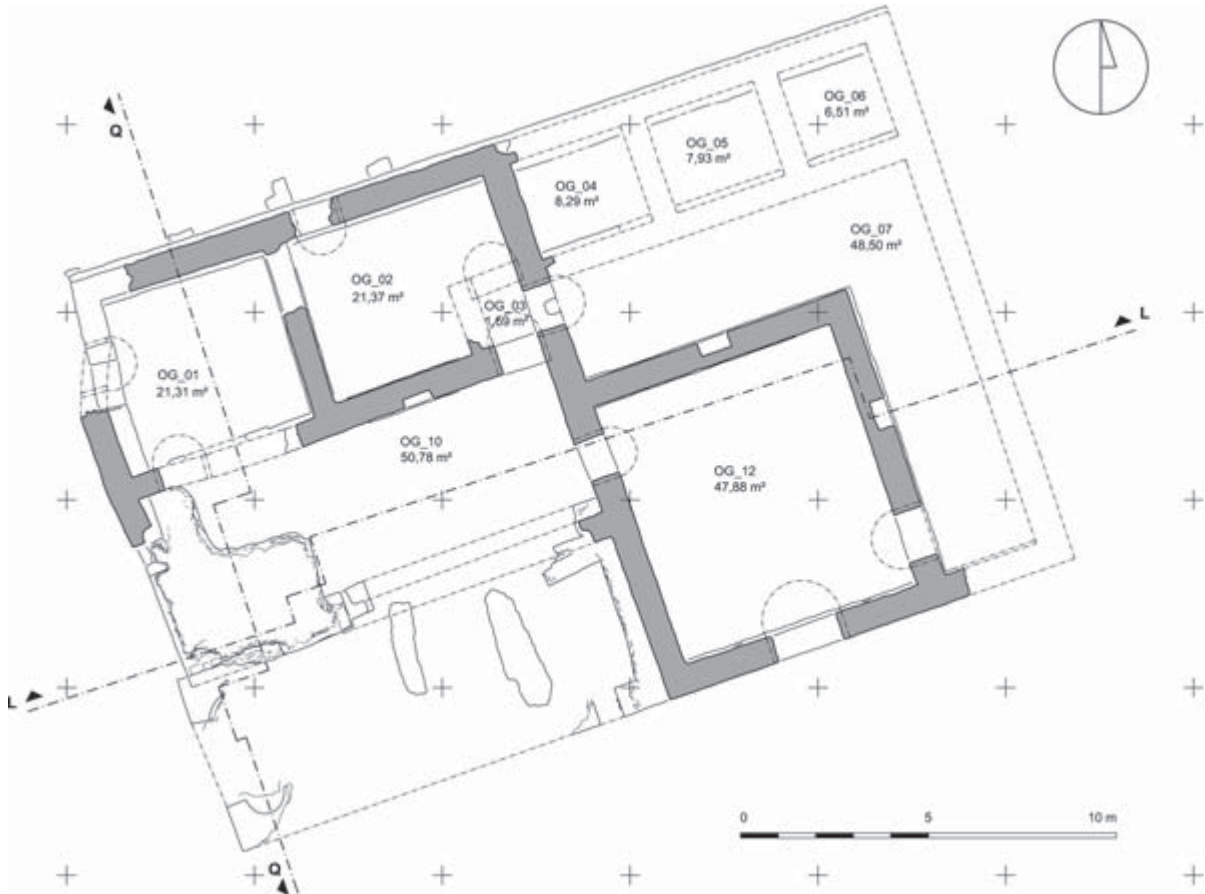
Kirse Yani, Bauaufnahme, Grundriß des Obergeschosses
